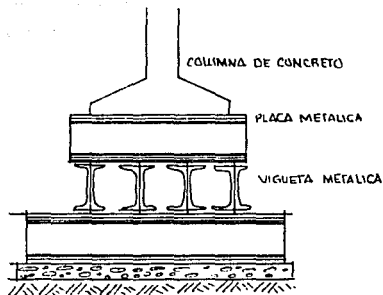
CIMENTACION CORRIDA O AISLADA METALICA, PROVISIONAL O DESMONTABLE.
